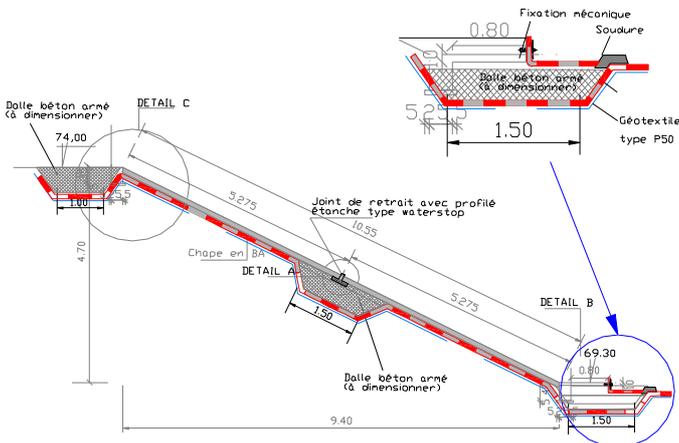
Dispositions constructives de protection de descente du matériel de curage
